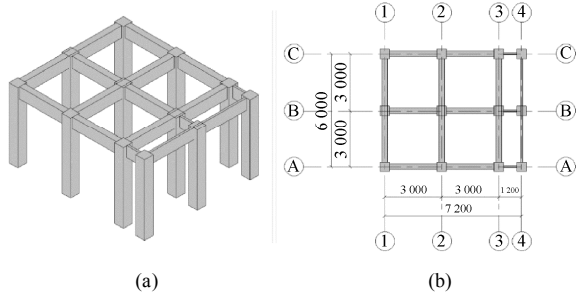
BIM 模型示意图((a)三维模型; (b)二维平面图)
